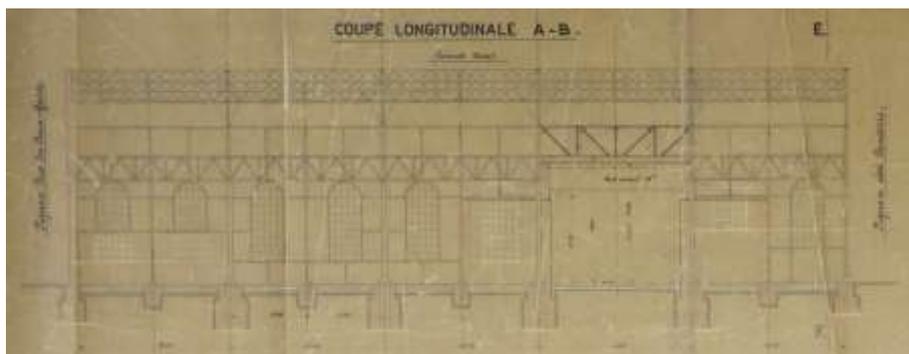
Coupe longitudinale façade ouest (détail) (AVV, 96.01, Fonds ACMV, Plans de la nouvelle halle de montage des turbines n°118/D115-124).
